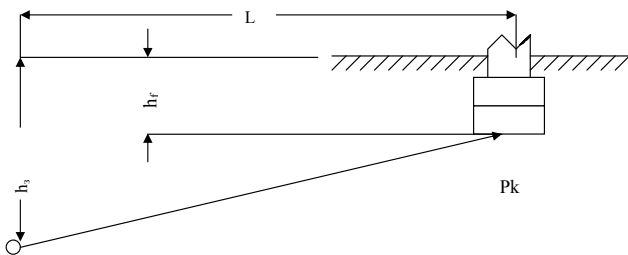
Схема воздействия импульса от взрыва на фундамент колонны
